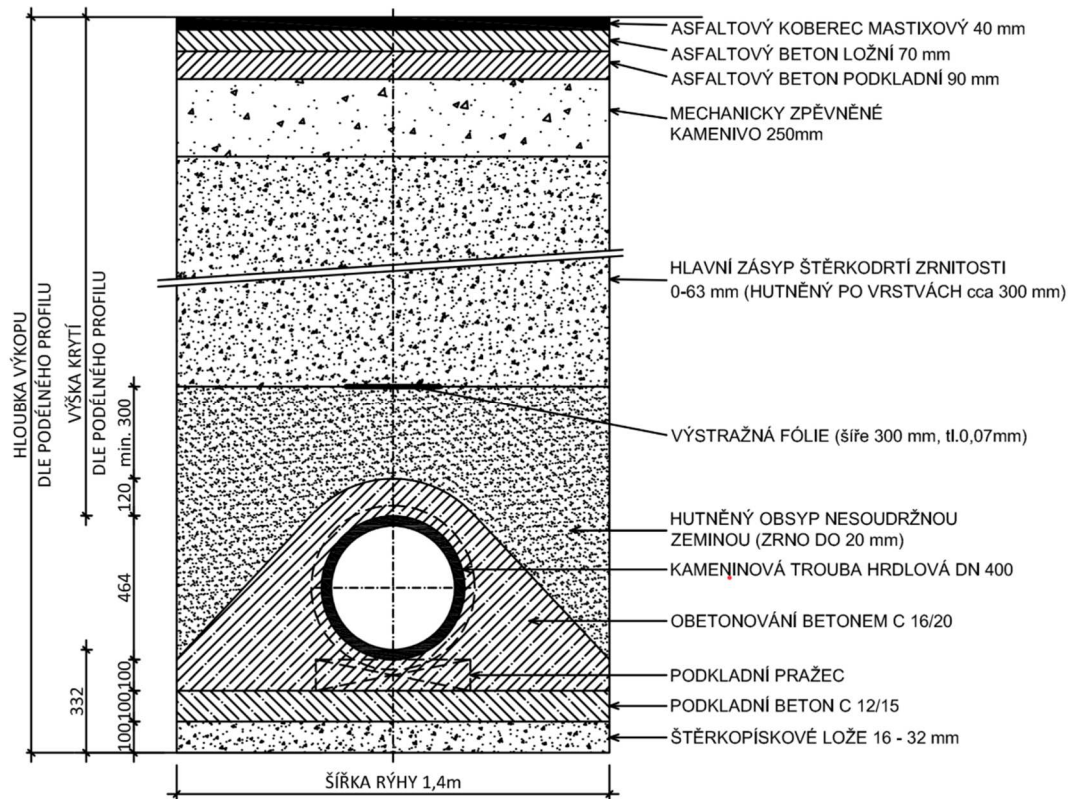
Vzorový řez kanalizace – beton DN 400 [Vlastní]
